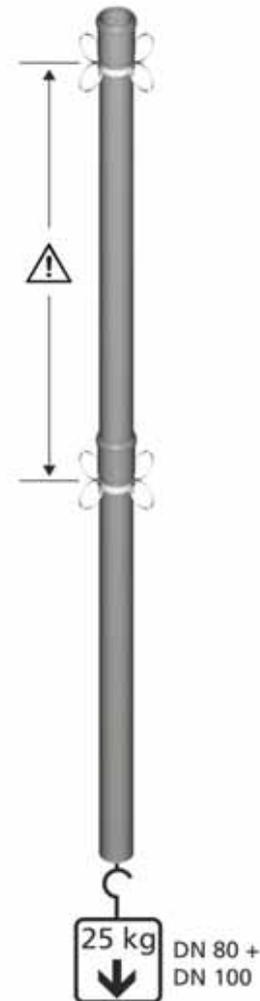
Abgasrohre mit Stoppring-Technik ①
